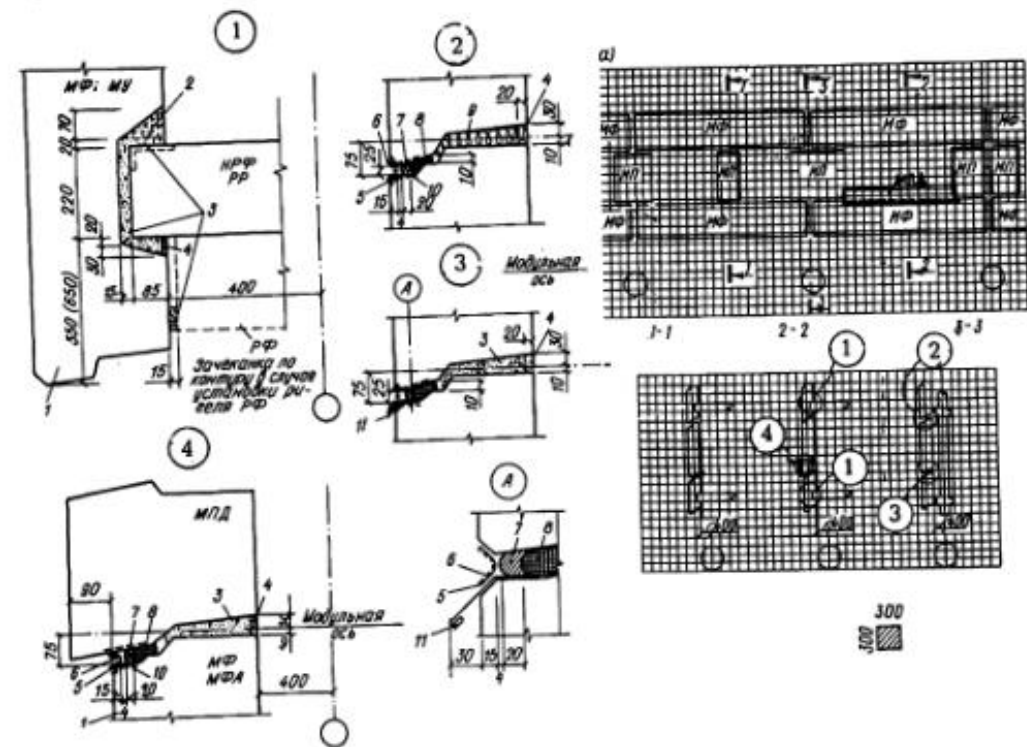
Узлы сопряжений панелей наружных стен а - фрагмент монтажной схемы фасада с горизонтальной резкой стен на панели; МФ - фасадная стеновая панель; МП - простеночная стеновая панель; МУ - панель уступа; МПД - подоконная стеновая панель; НРФ - настил-распорка фасадная; РР - ригель-распорка; 1 - панель наружной стены; 2 - опорный узел; 3 - цементный раствор; 4 - затирка; 5 - герметизирующая лента; 6 - краска; 7 - герметизирующая мастика; 8 - гернит; 9 - смоляная пакля; 10 - клей-герметик; 11 - слив из оцинкованной стали
